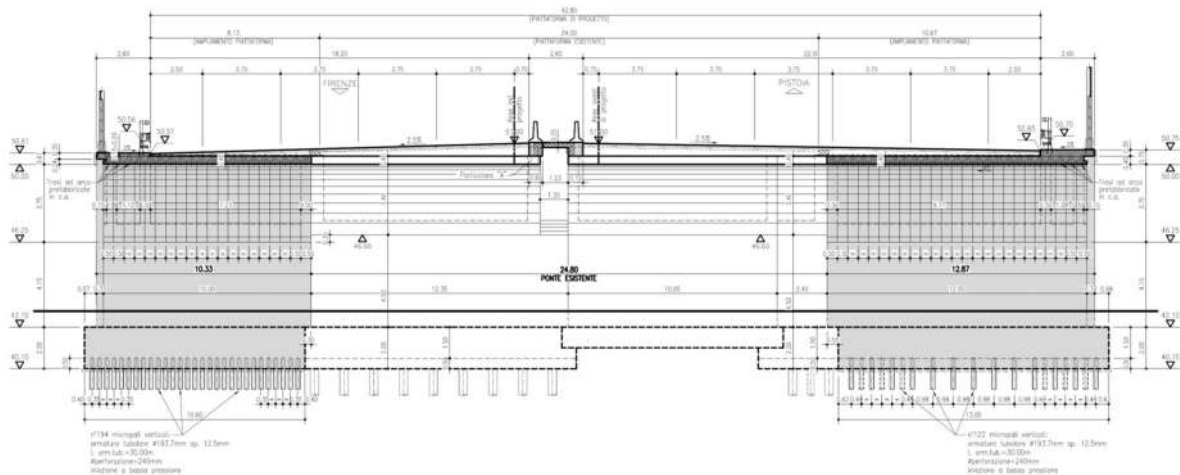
Sezione trasversale dell'impalcato allargato
